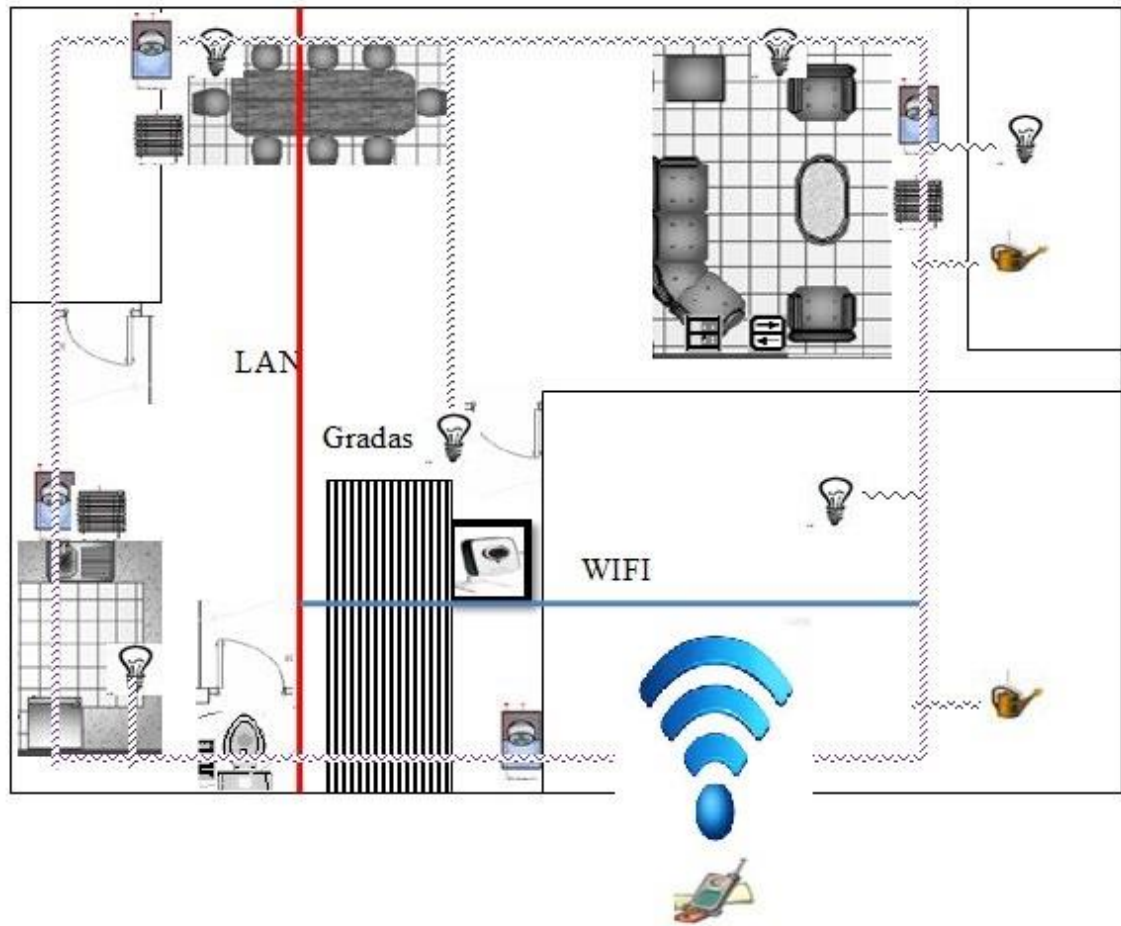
Instalación de la Red Domótica y Red Eléctrica en la Planta baja de la Vivienda.
